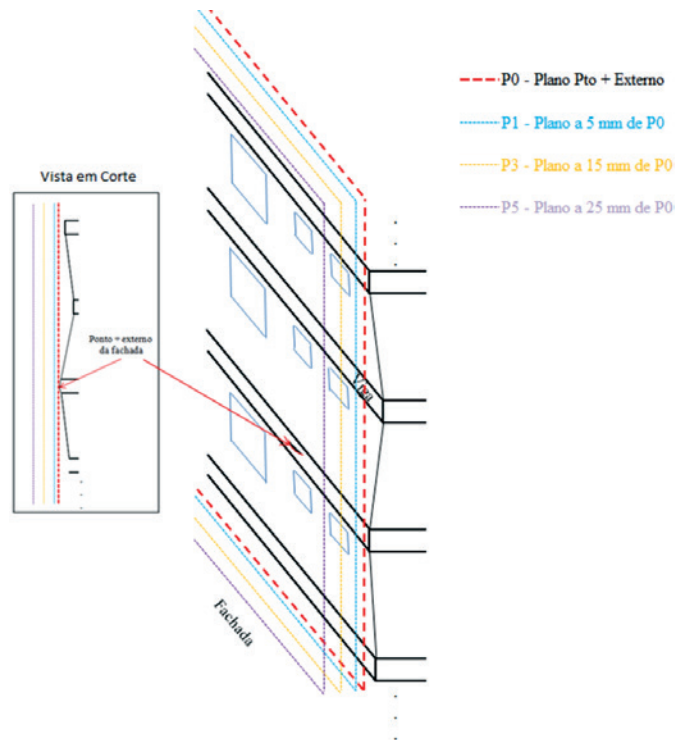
(a) Detalhe do ponto mais externo da fachada no Plano 0'; (b) Ilustração dos planos a 5mm (azul), 15mm (amarelo) e 25mm (cinza) em relação ao plano (vermelho) traçado a partir do ponto mais externo da fachada
